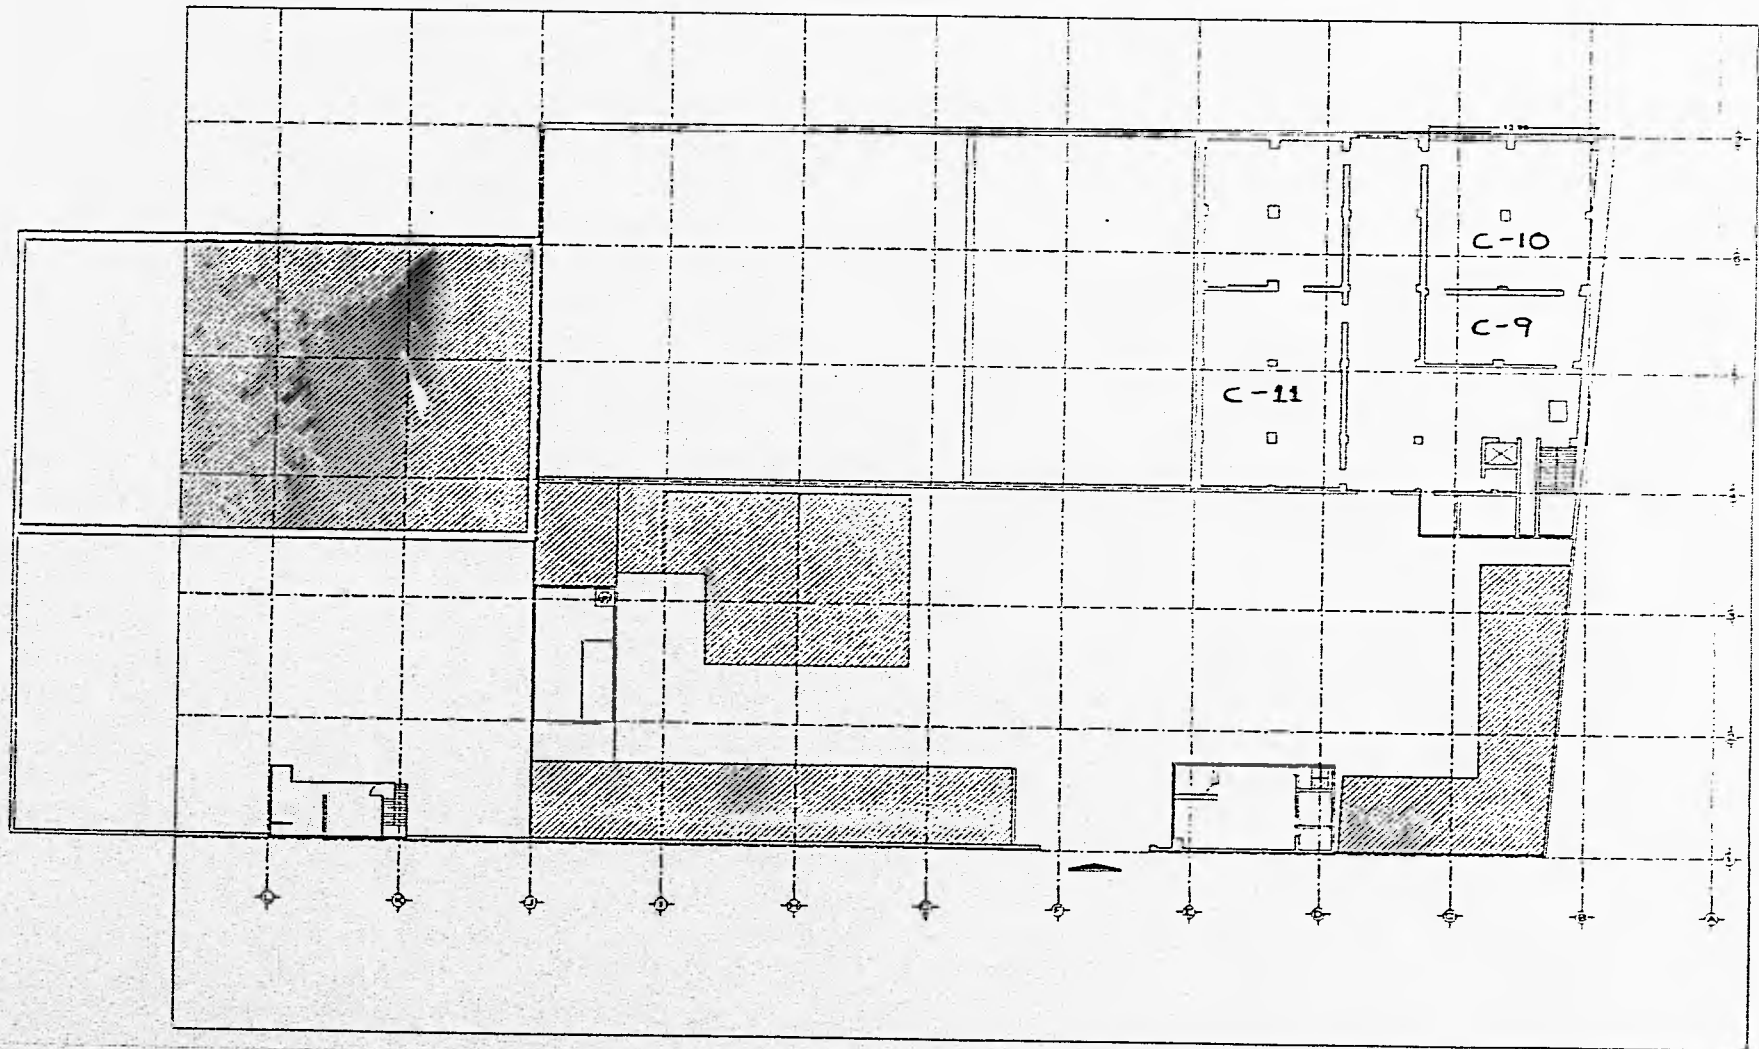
A VISTA SUPERIOR DE LA PLANTA [PRIMER NIVEL, SIN ESCALA].
